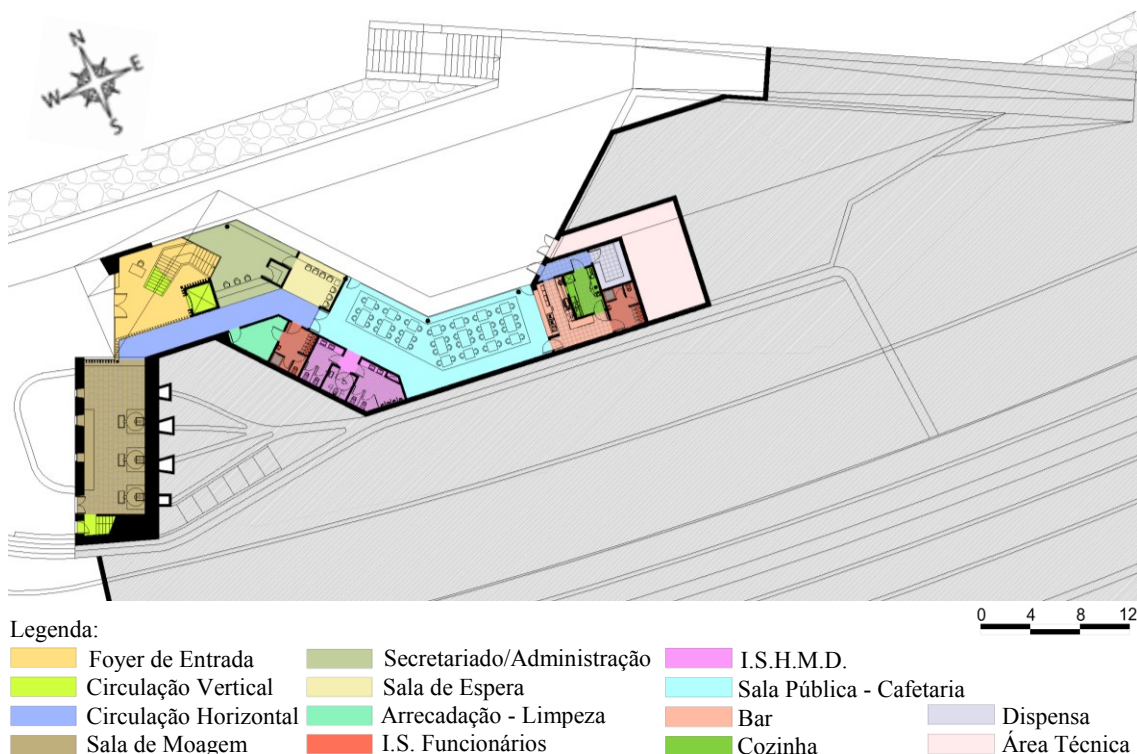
Planta do Piso 0 (Fonte: do autor)
